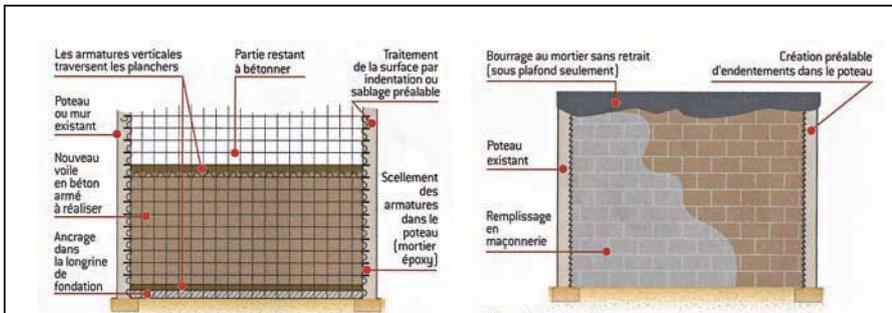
Exemple de renforcement du contreventement d'un bâtiment par création de murs nouveaux entre deux poteaux existants (élévation)
